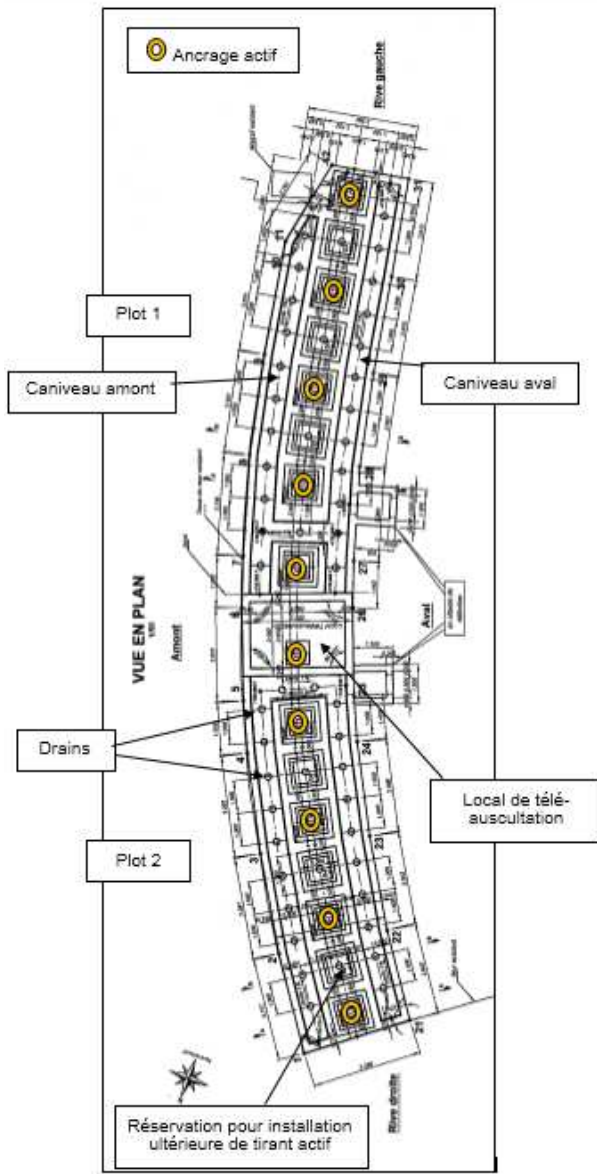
vue en plan de la structure précontrainte construite face aux plots n°1 et n°2.
